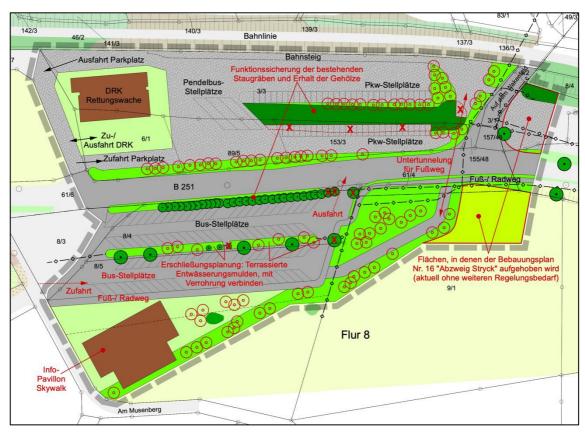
Lageplan - Ausschnitt Grünordnungskonzept (rot: geplant, schwarz: bestehend)
